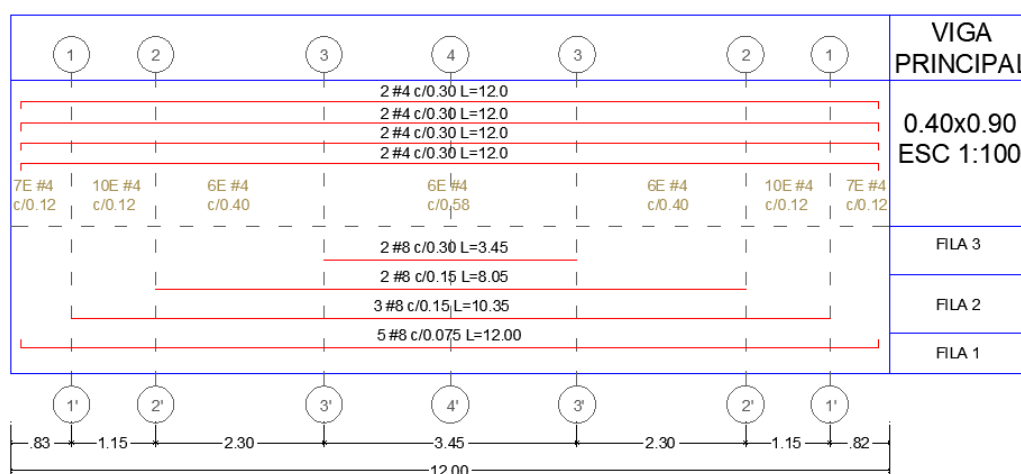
Despiece general de las vigas para un puente de concreto reforzado de 12 metros. (ver anexo 02 página 01)
